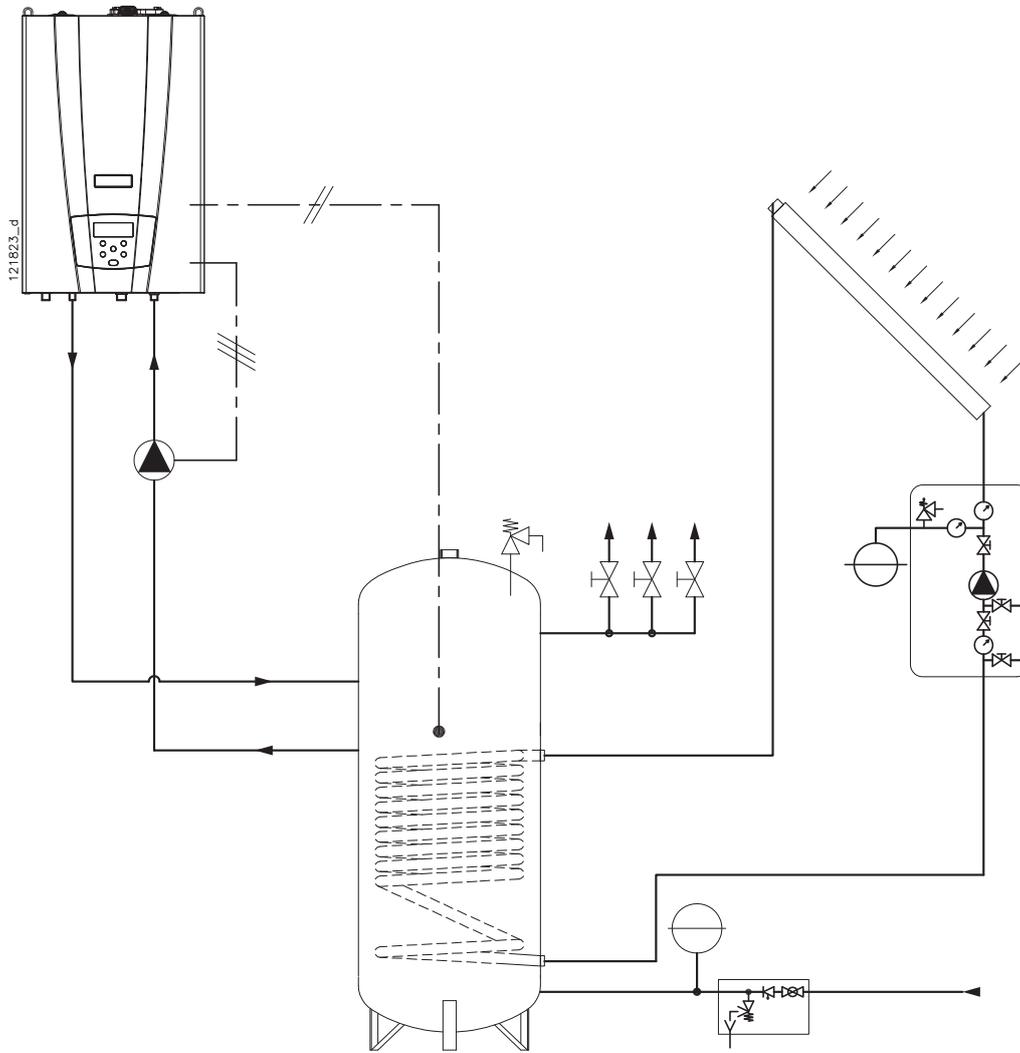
Exemple d'installation avec panneaux solaires et ballon (chapitre 5.14)
